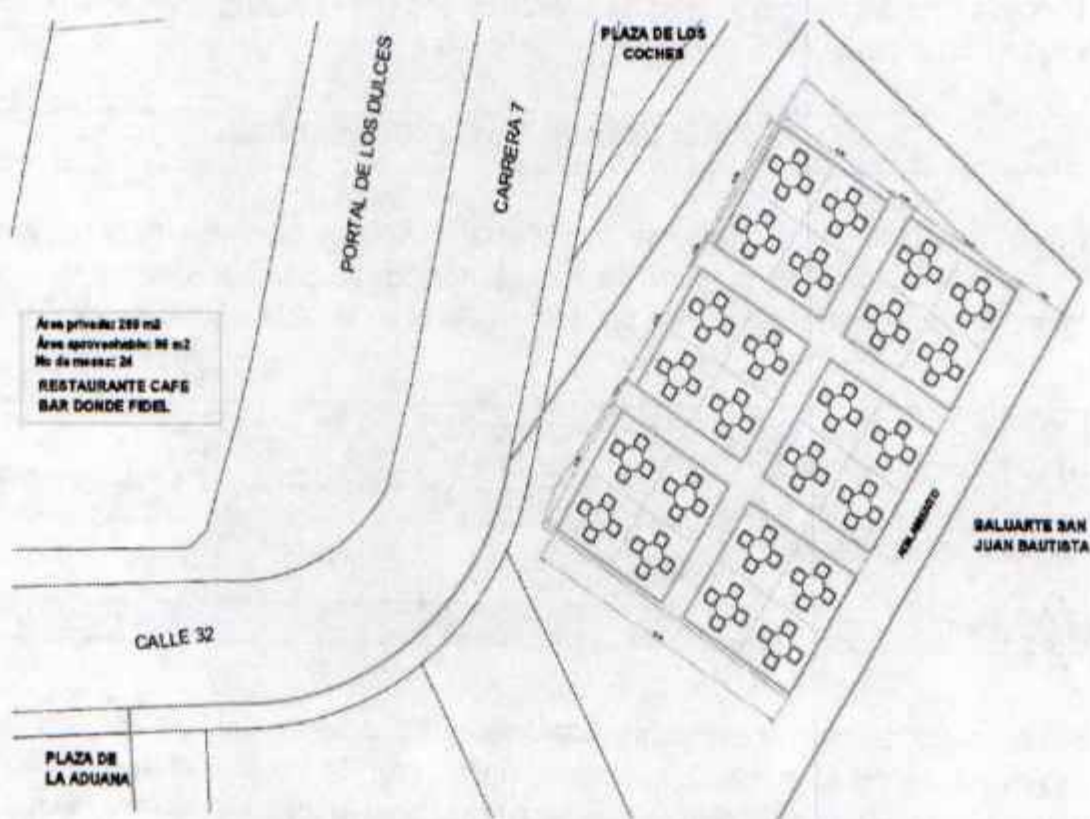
Plano Distribución de mobiliario Plaza Alcalde Pareja
